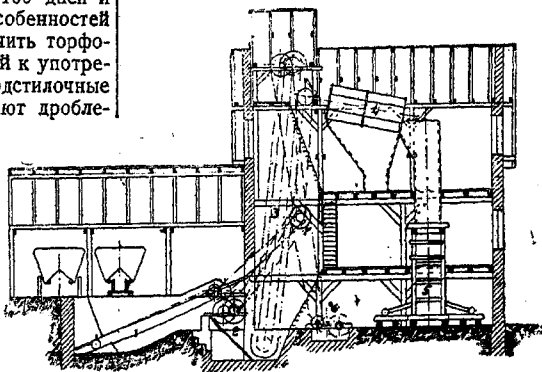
Схема торфоподстильного завода: 1—транспортер; 2—волк-машина; 3—элеватор; 4—сито; 5—пресс; 6—лебедка; 7—транспортная лента.
